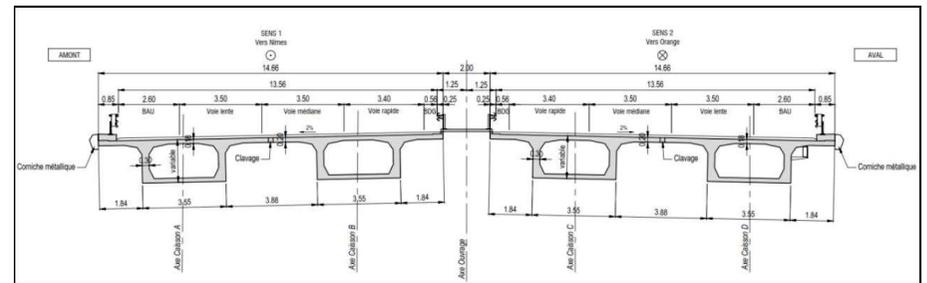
Coupe transversale fonctionnelle de l'ouvrage (Arcadis, 2022)
